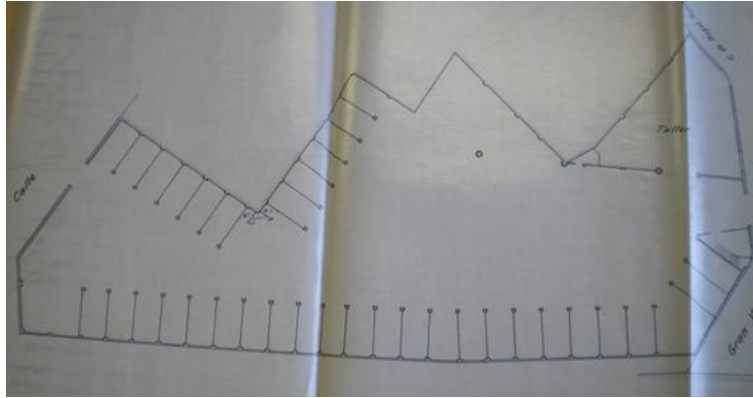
Distribución en Planta del Garaje Antolí (izada).
